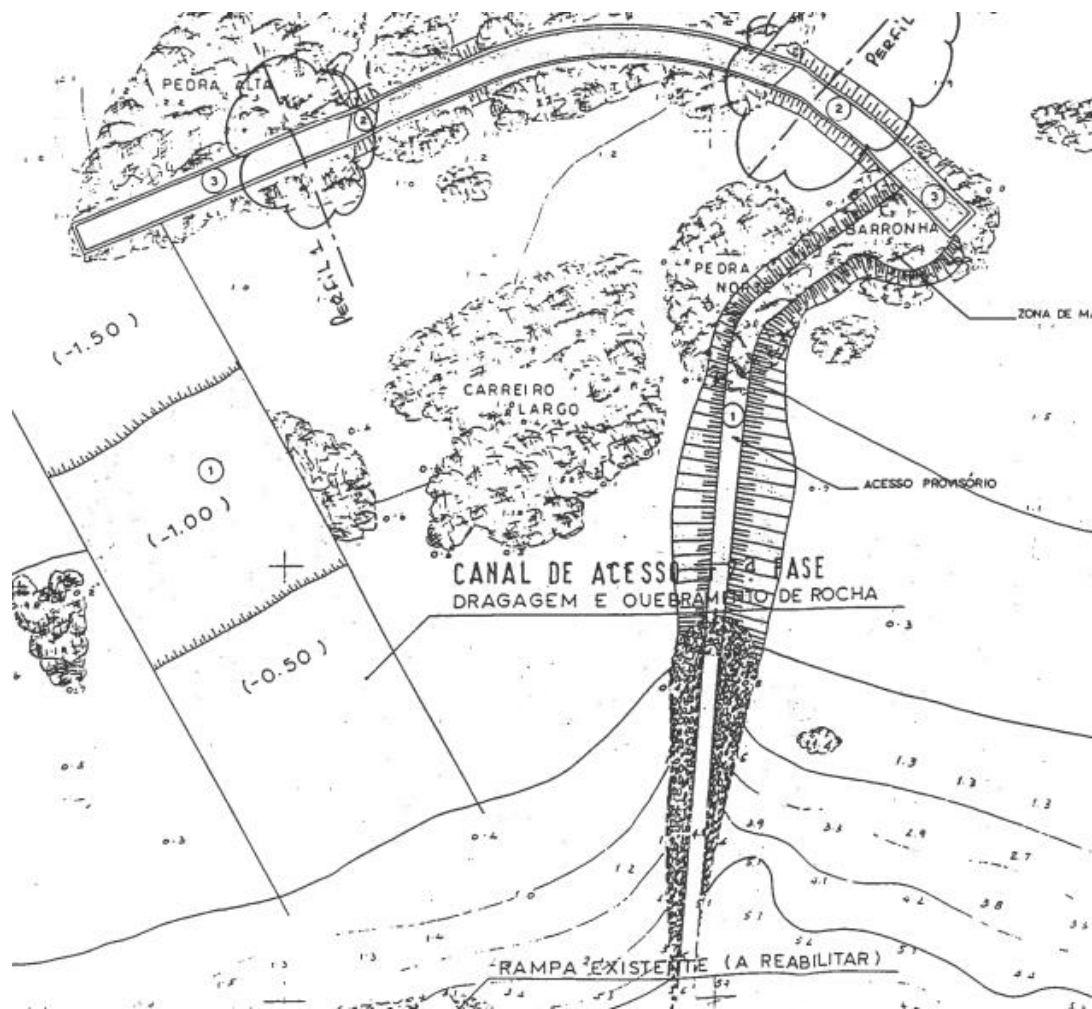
Planta relativa à fase construtiva do quebramar destacado da Pedra Alta. [2]
